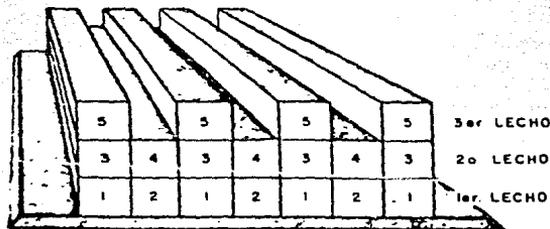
SECUENCIA DE COLADO DE PILOTES DE SECCION CUADRADA.
